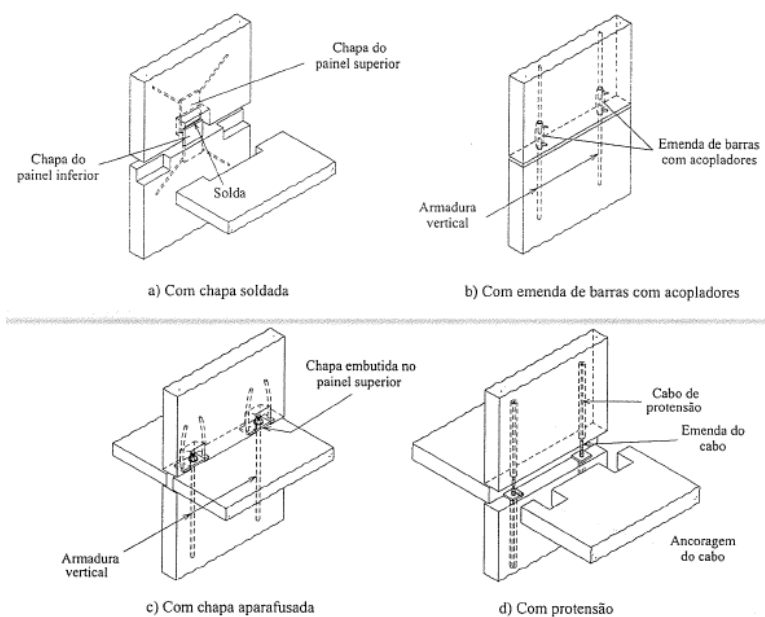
Ligações parede-parede na direção horizontal [6]
